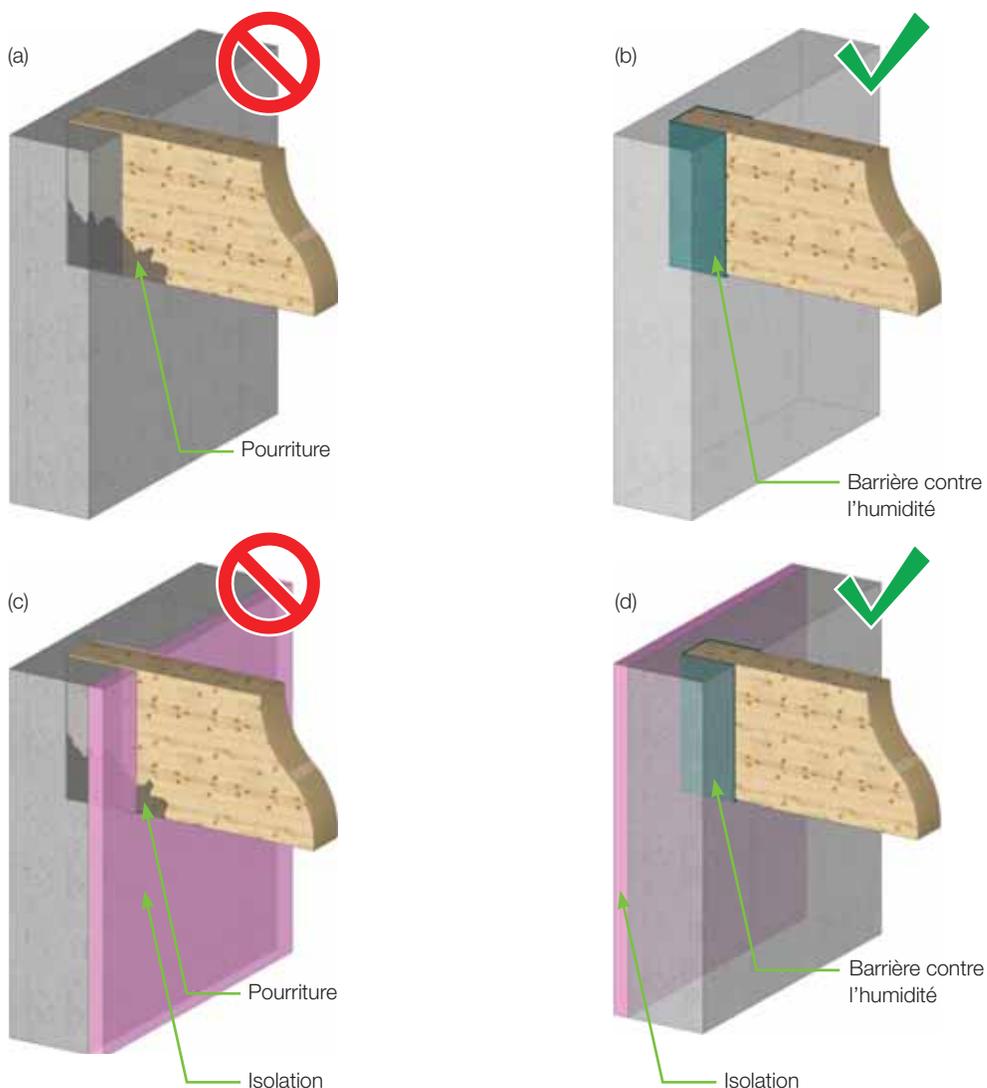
• Appui d'une poutre sur du béton ou de la maçonnerie
